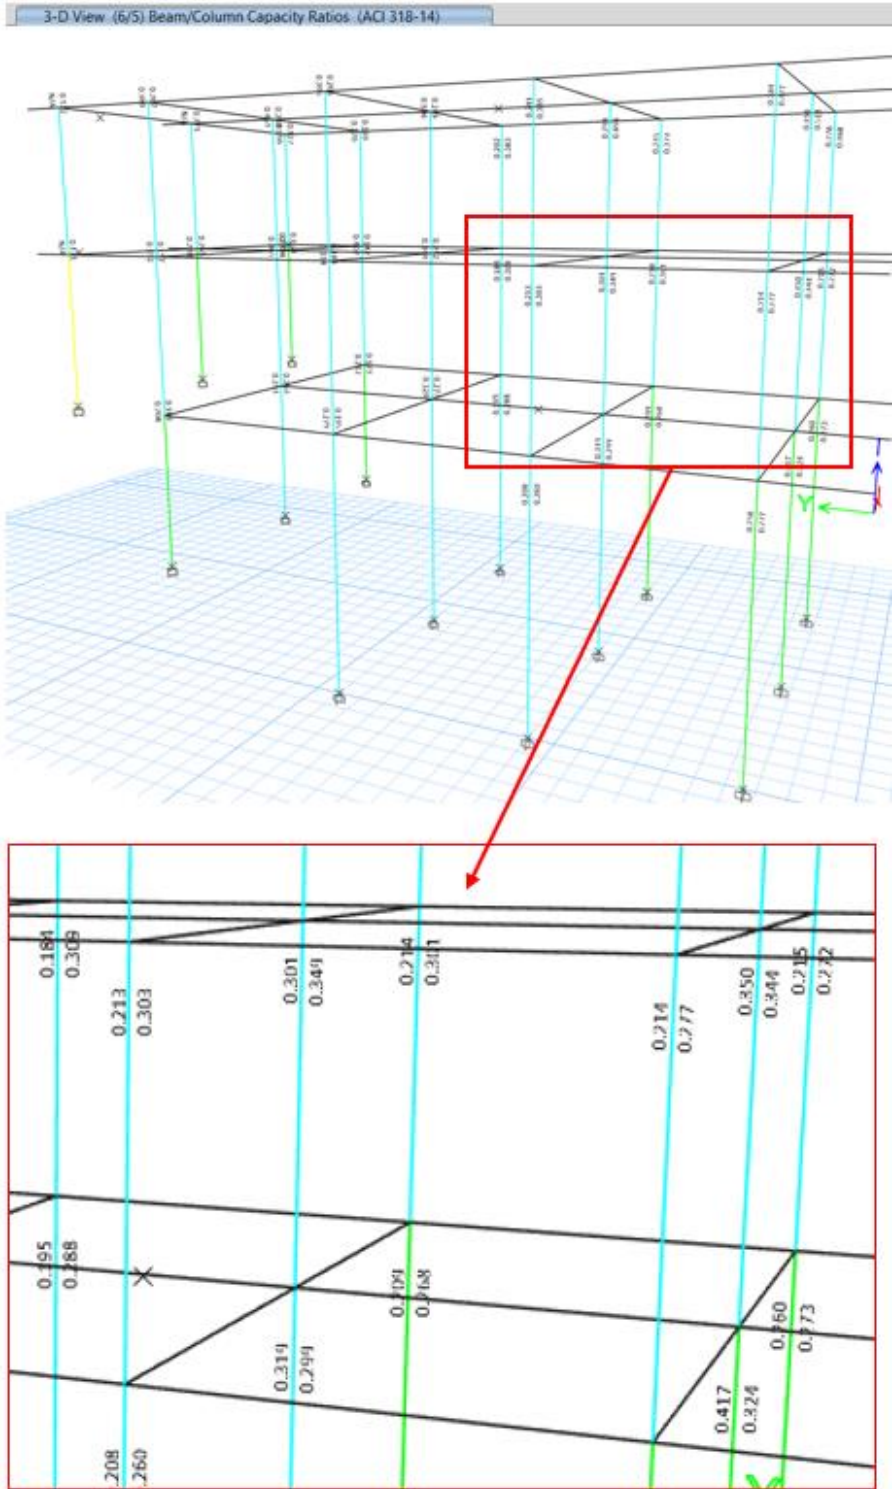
Análisis de columna Fuerte-Viga débil aplicado en Etabs.
